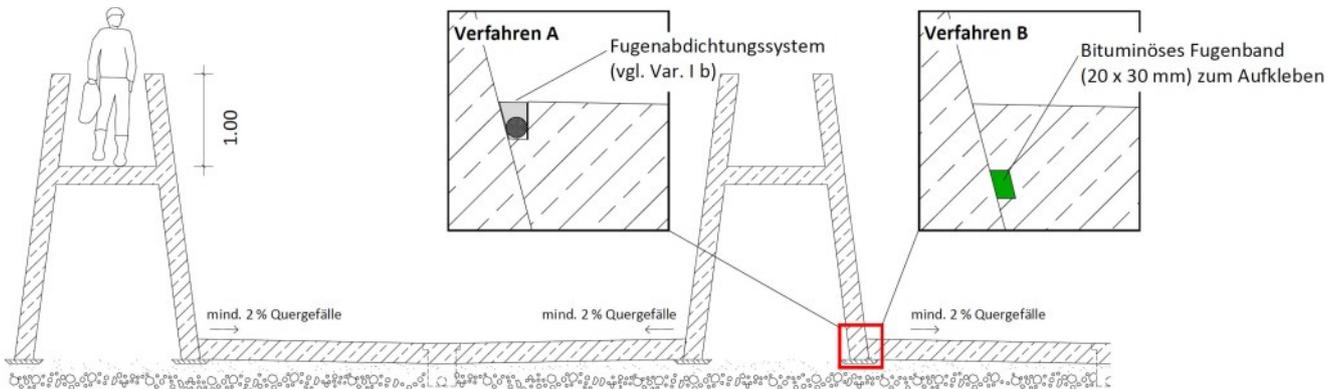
Ort beton - Betonfertigteil begehbar (schräge Wand)
